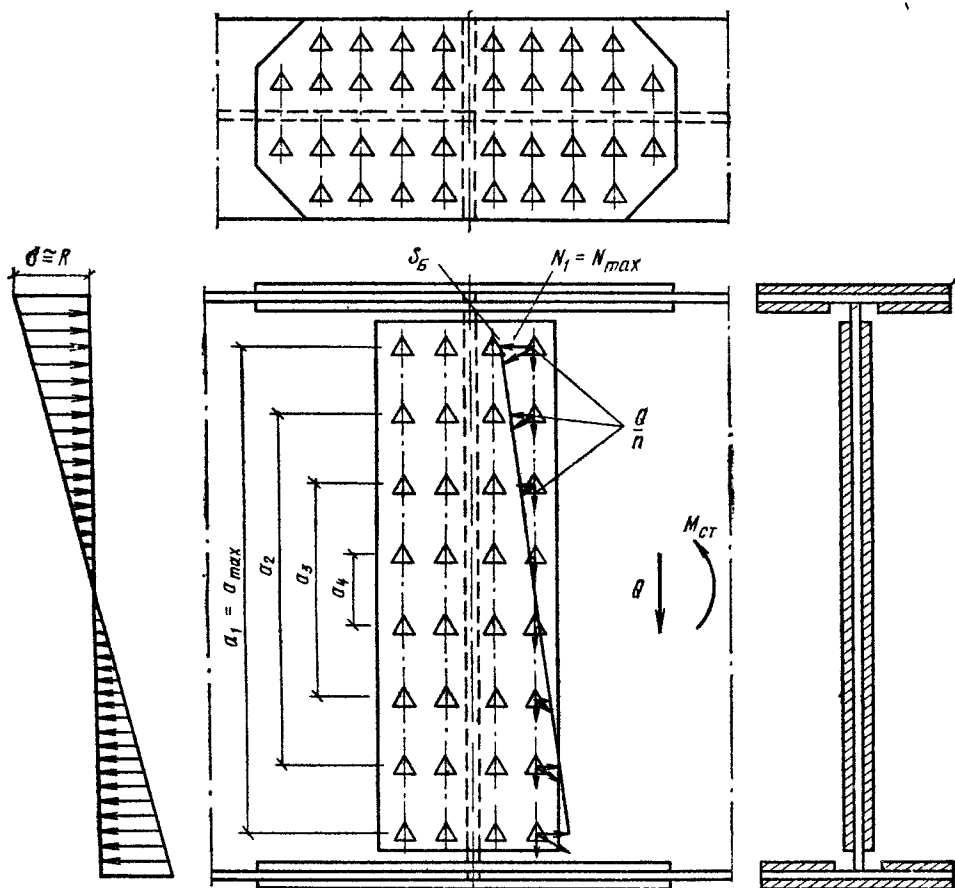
Монтажный стык сварной балки на высокопрочных болтах
